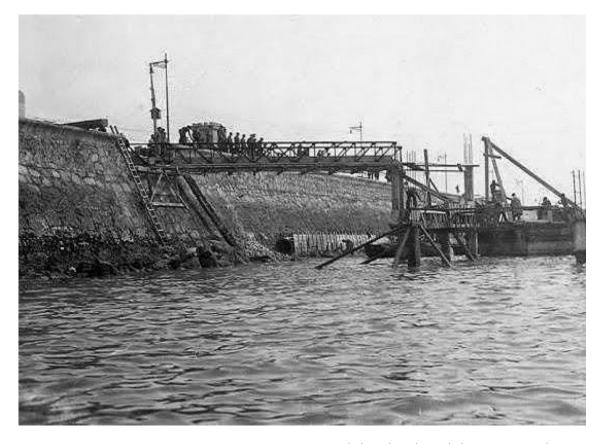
HISTORIADEUNBUZO. (1933). Construcción de los pilotes base de hormigón armado.
